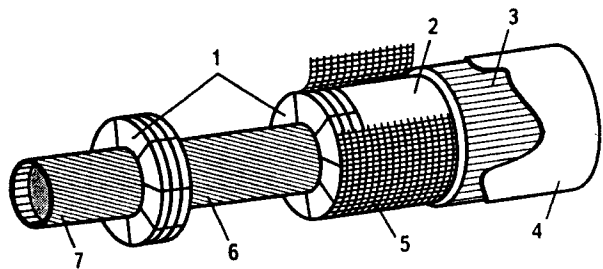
Конструкция изоляции, выполненная набивкой под сетку:
